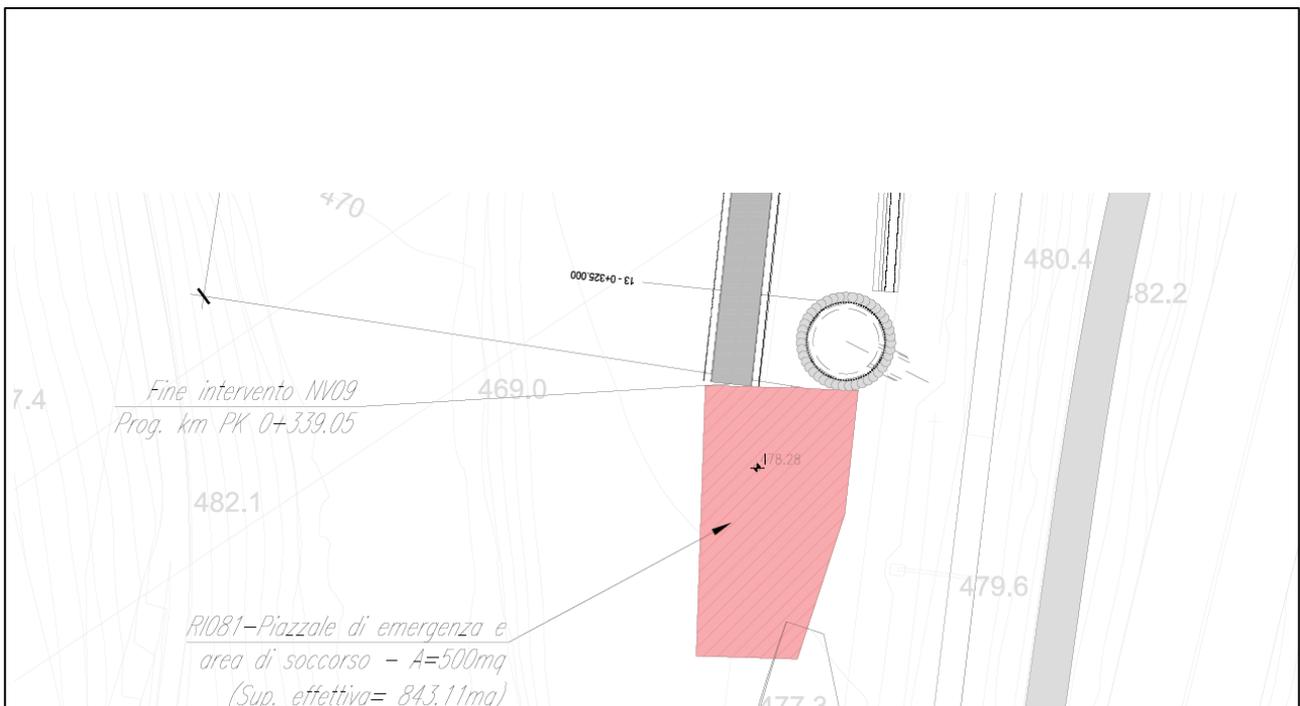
Planimetria di progetto piazzale di emergenza e area di soccorso interconnessione pari
